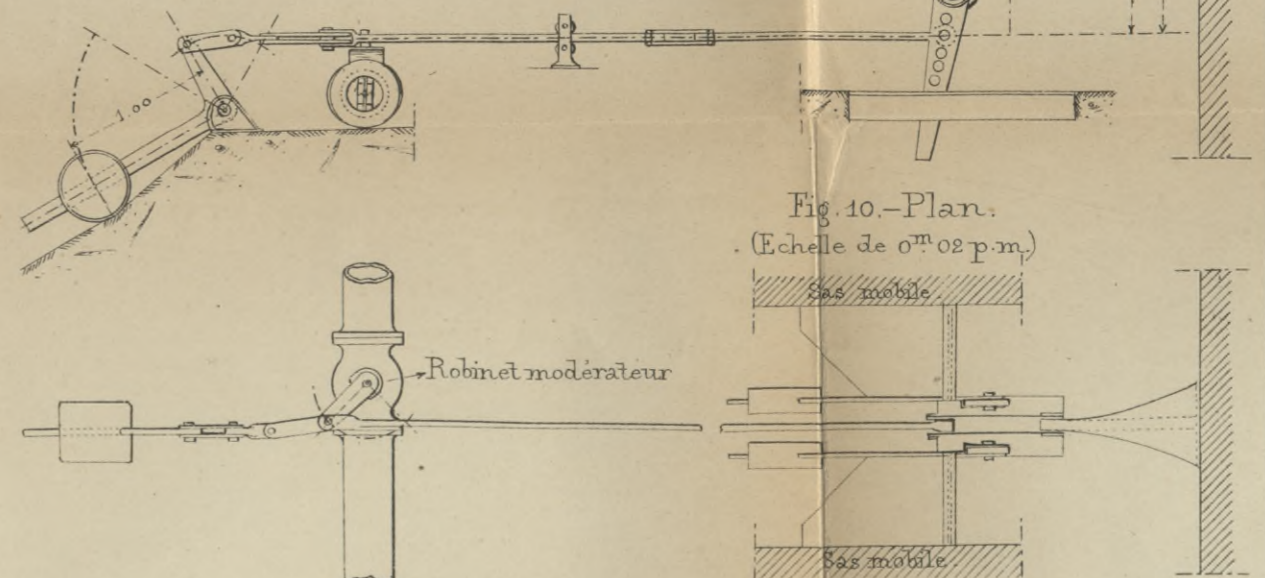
Plan. (Echelle de 0^m.02 p. m.)
